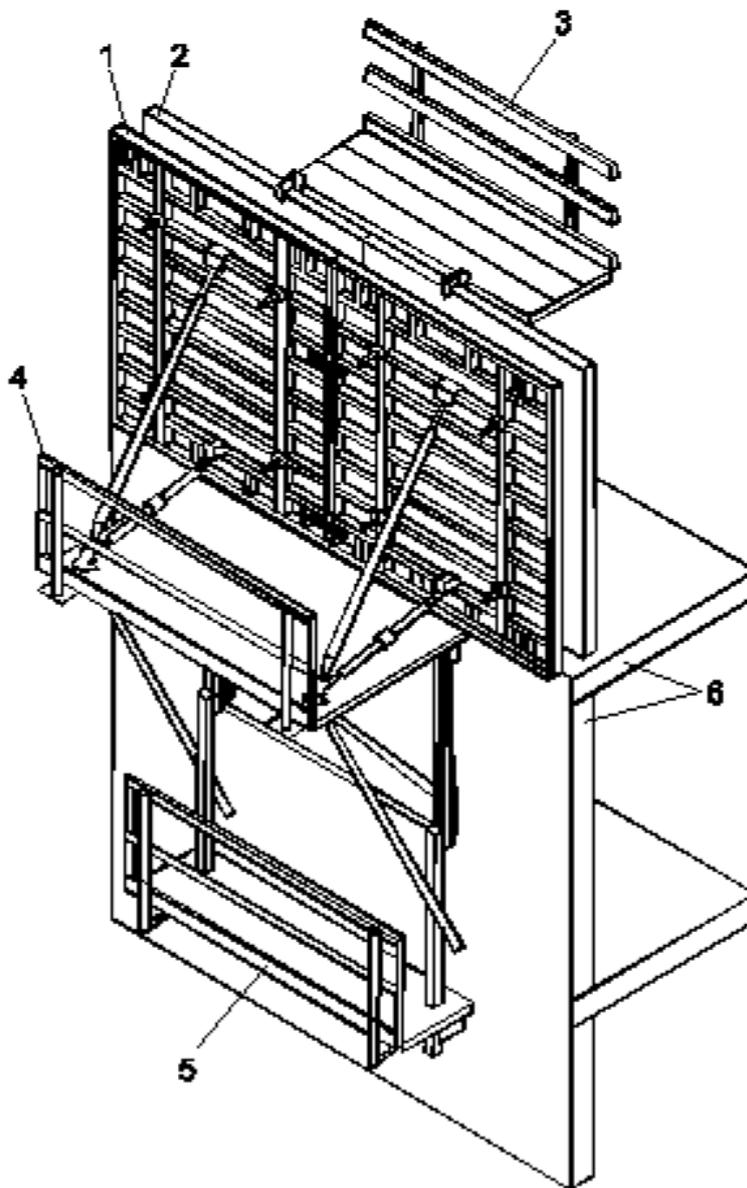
Схема устройства подъемно-переставной опалубки наружных стен 1 — наружная опалубочная панель; 2 — внутренняя опалубочная панель; 3 — навесные подмости; 4 — рабочие подмости; 5 — нижние подмости; 6 — монолитные конструкции
